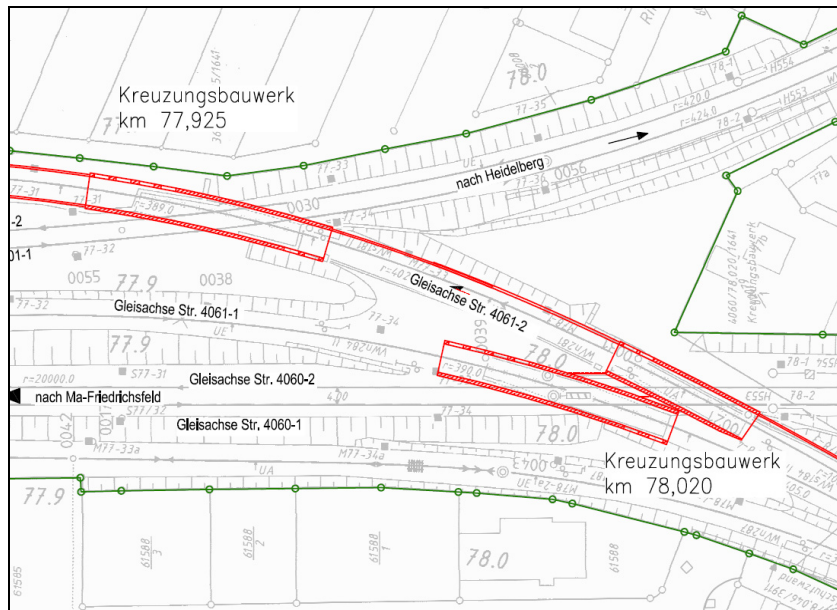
Auszug aus dem Übersichtslegeplan der Planfeststellungsunterlagen mit Markierung (rot) der zu erneuernden Kreuzungsbauwerke (Quelle: DB Projektbau GmbH (2012), Anlage 04)
